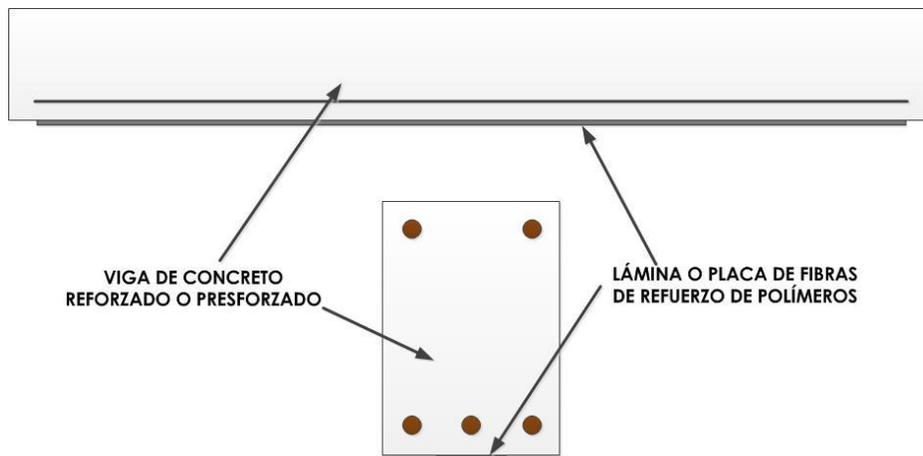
Diseño de refuerzo con láminas de FRP (Ryall, 2001)
